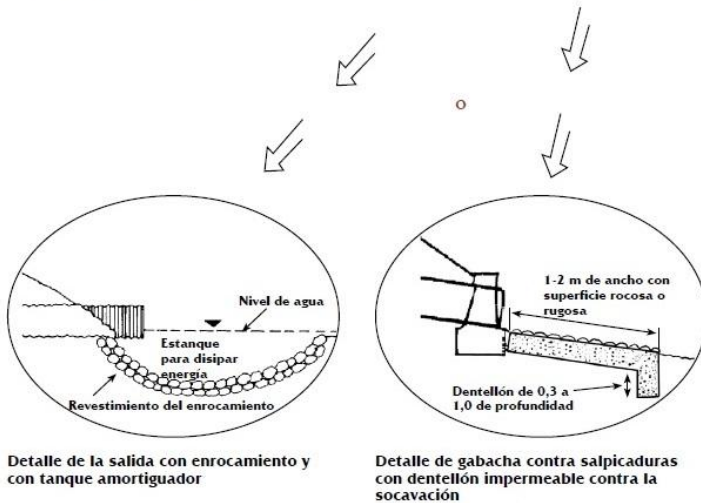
Instalación de alcantarillas y detalles de protección de la boca de salida, con vertedores contra salpicaduras o con tanque amortiguador revestido de enrocamiento.
